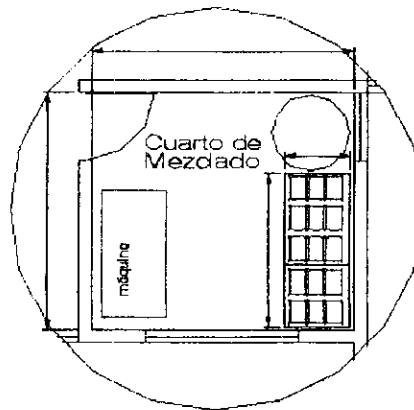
PLANO CUARTO DE MEZCLADO
